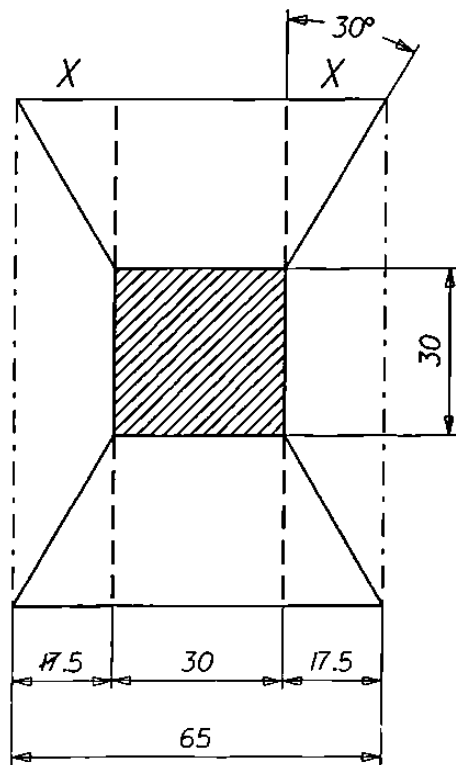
J2 CRITERIO PARA DETERMINAR ANCHO EFECTIVO DE LOSA
